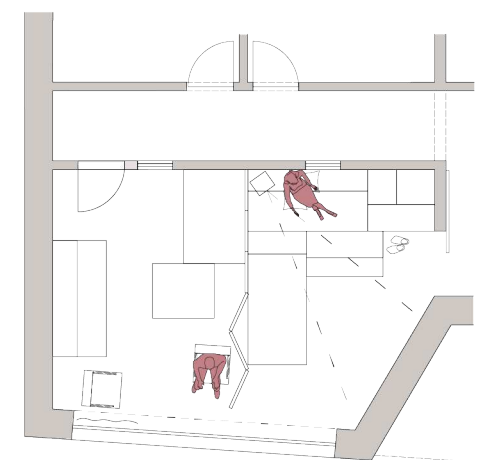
Grundrissvariante 4 - Parallele Nutzung individuell und individuell
